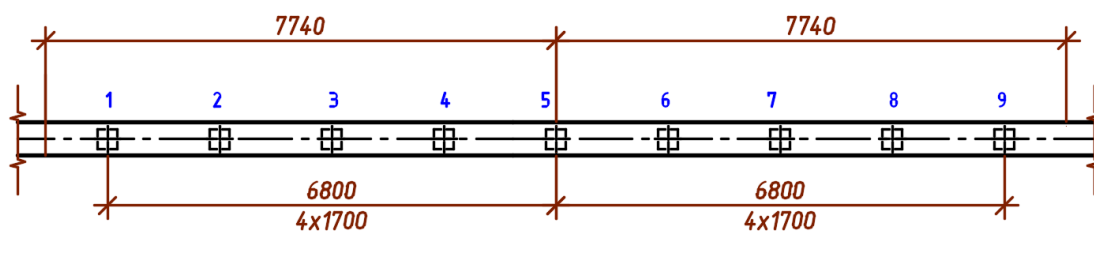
К расчету осадки свайного фундамента по осям В, Ж
